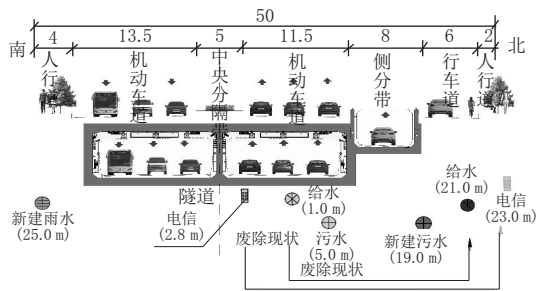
朱雀大街至长安南路段道路横断面布置图(单位:m)
